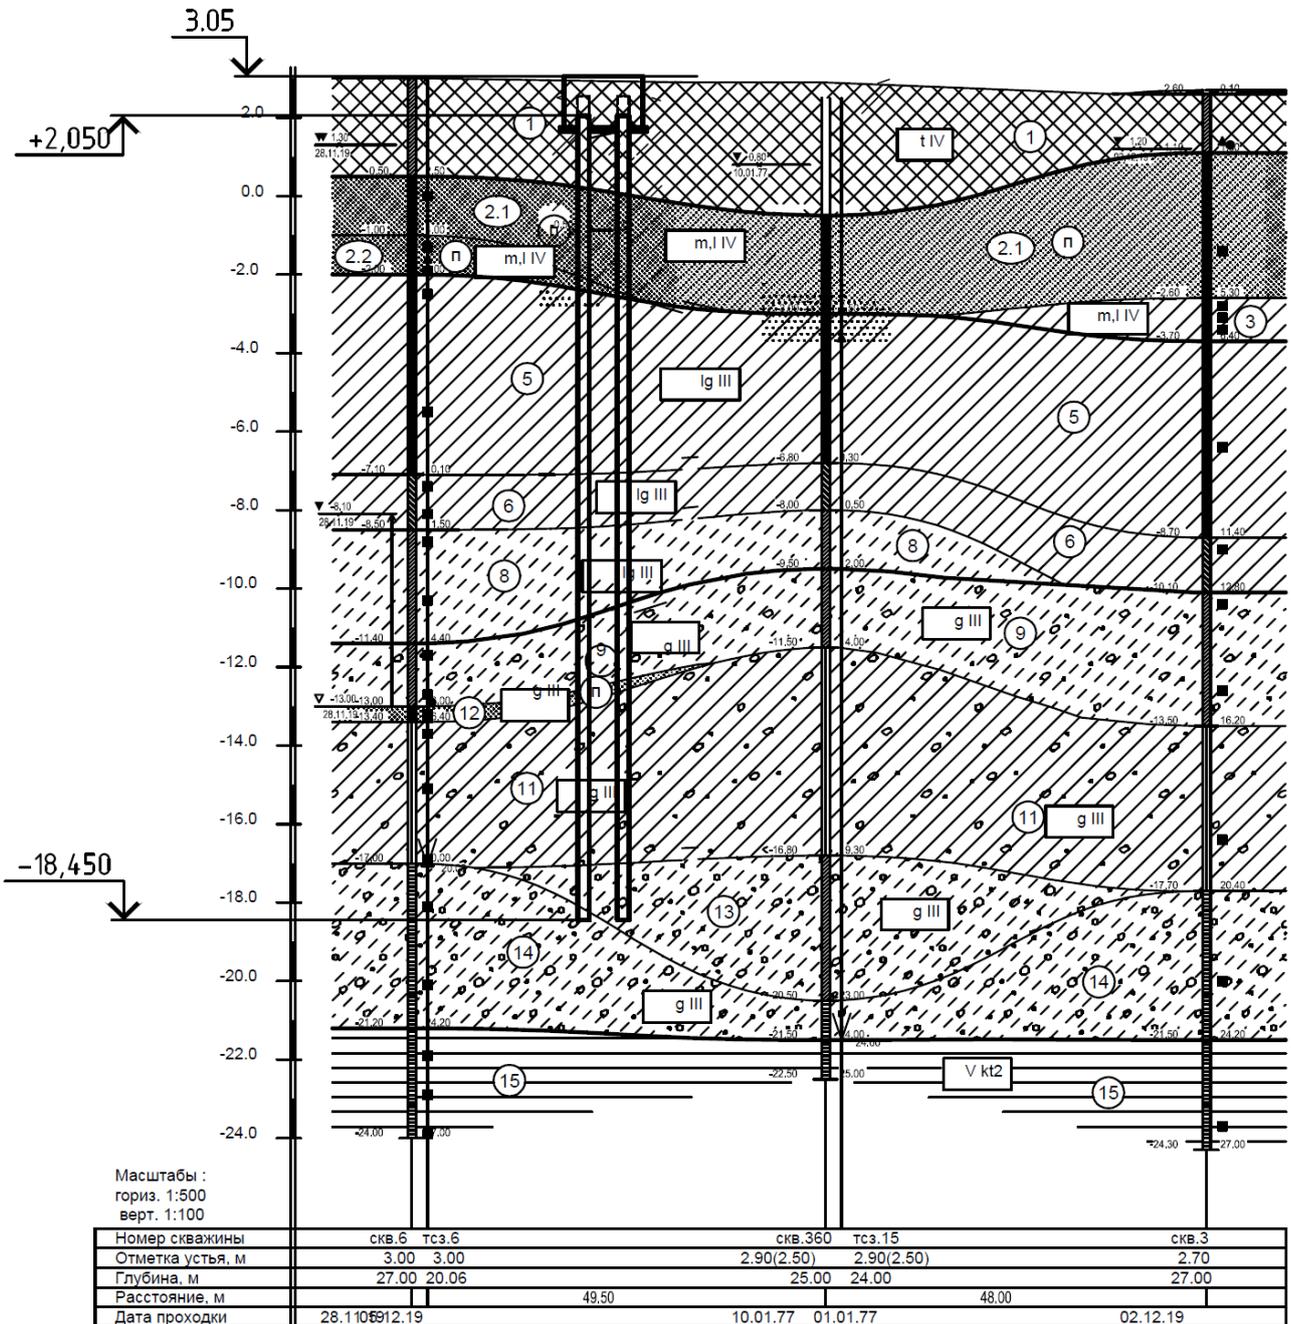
Привязка свай к инженерно-геологическому разрезу
